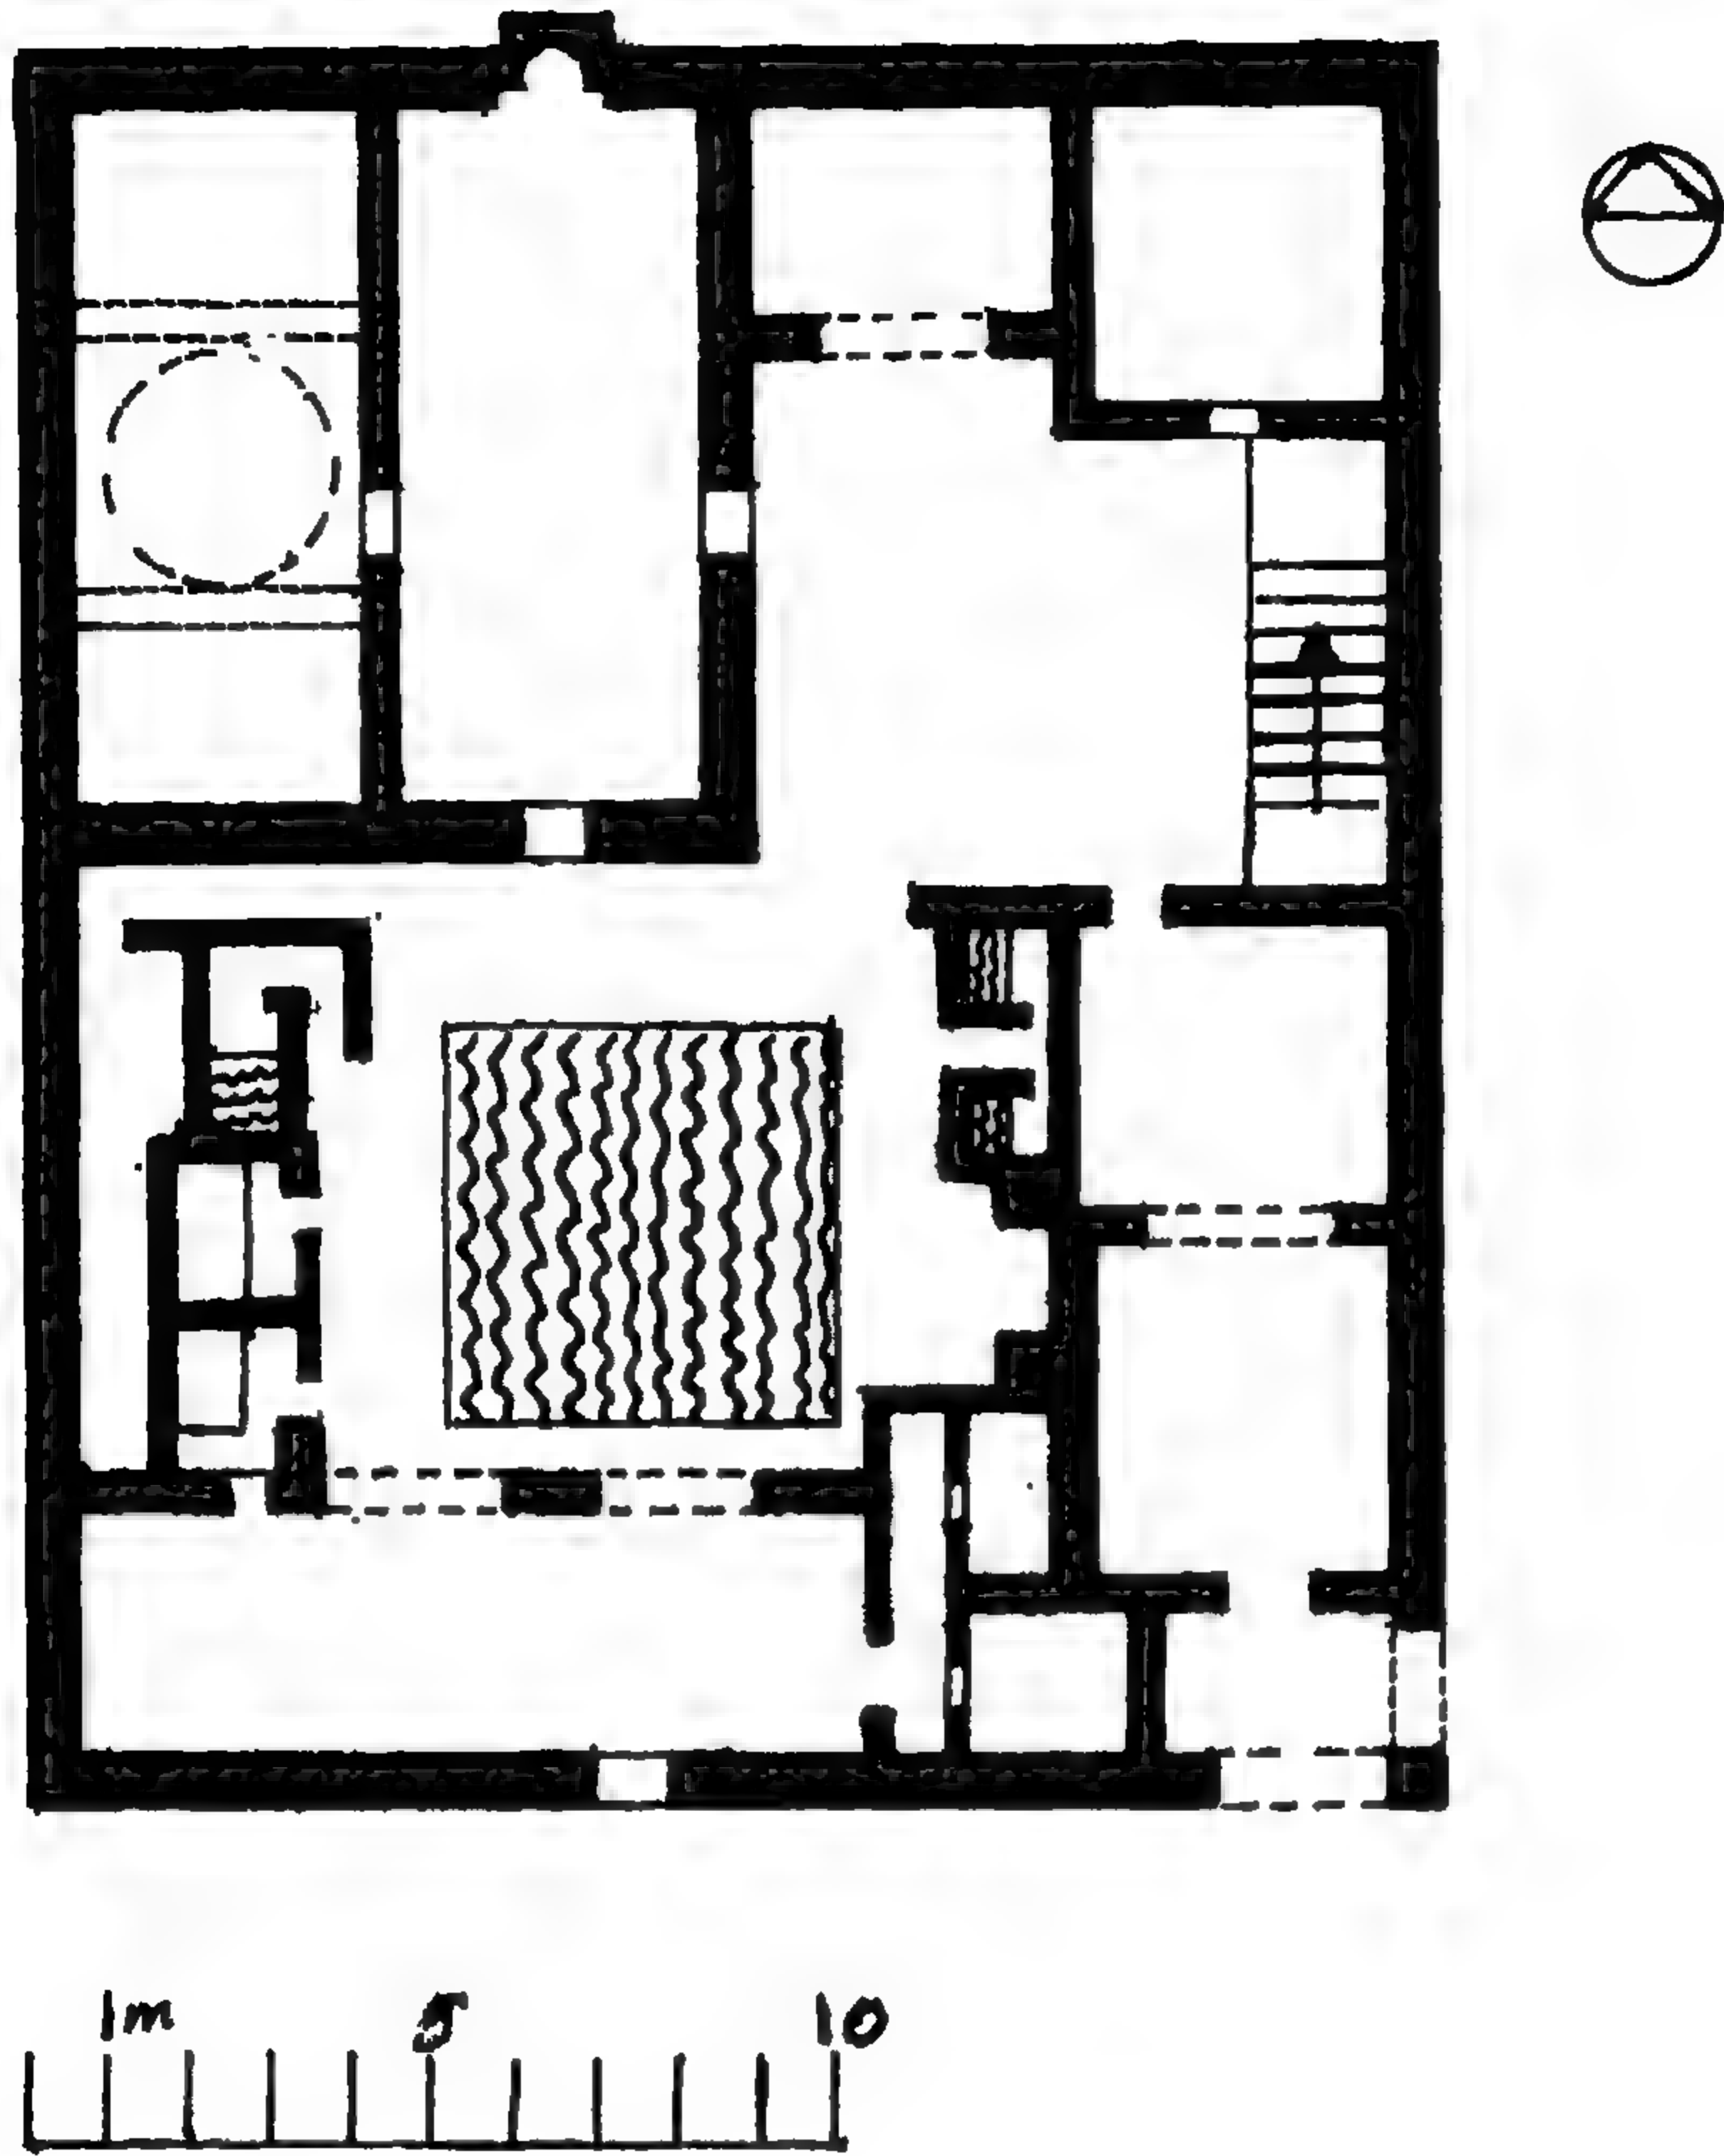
مسقط أفقي لجامع المظفر بمدينة تعز (عن Noha Sadek)
